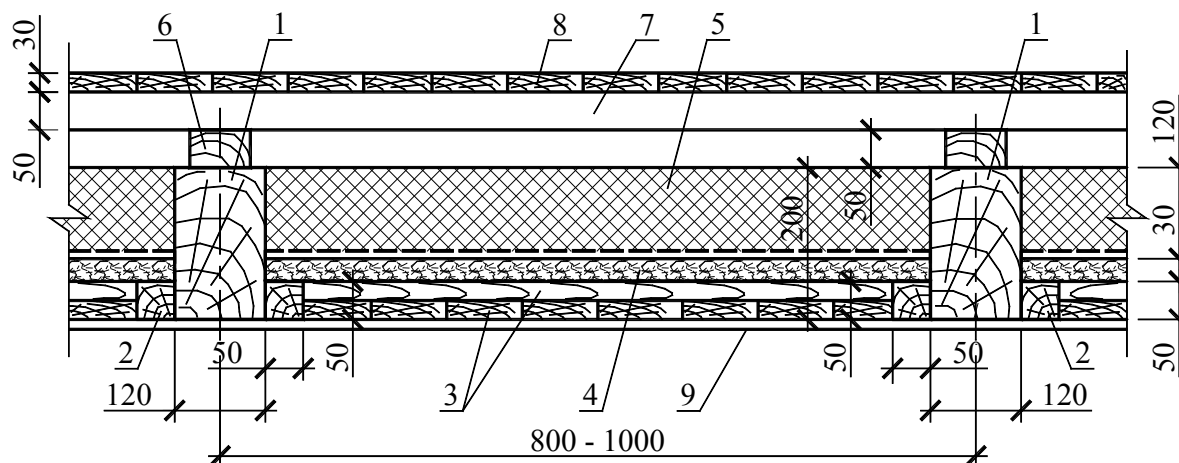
Схема межэтажного деревянного перекрытия: 1 – деревянная балка; 2 – черепной брусок; 3 – деревянный щитовой накат; 4 – обмазка глиной; 5 – звукоизоляционный материал; 6 – деревянная подкладка; 7 – деревянная лага; 8 – половая доска; 9 – обшивка потолка
